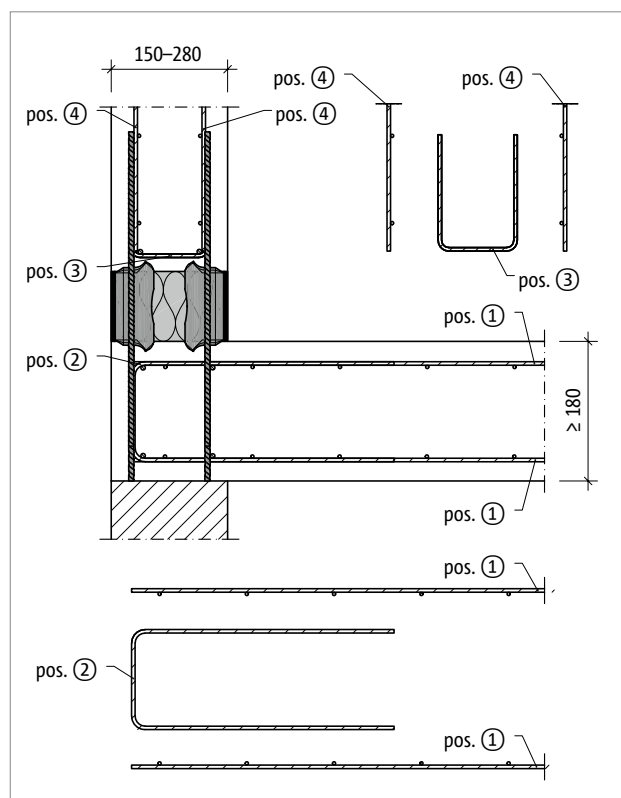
Schöck Isokorb® CXT typ AP Part Z: Půdorys prvku
